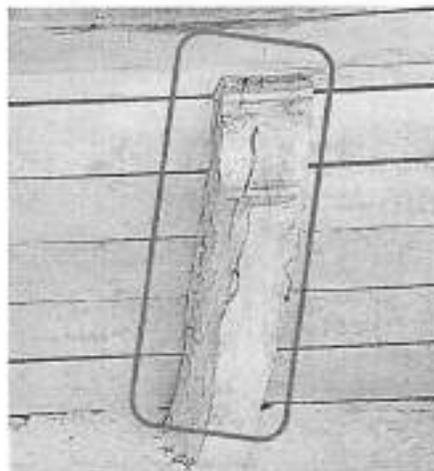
Vigas de madera agrietadas (Fuente: Autor)
